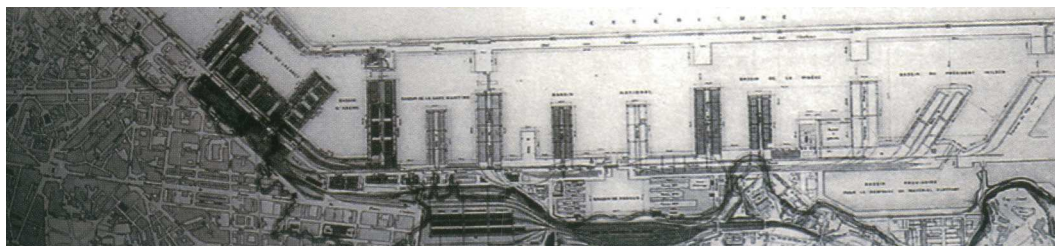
Planta do plano de Marselha para as novas docas de Joliette, 1820.
